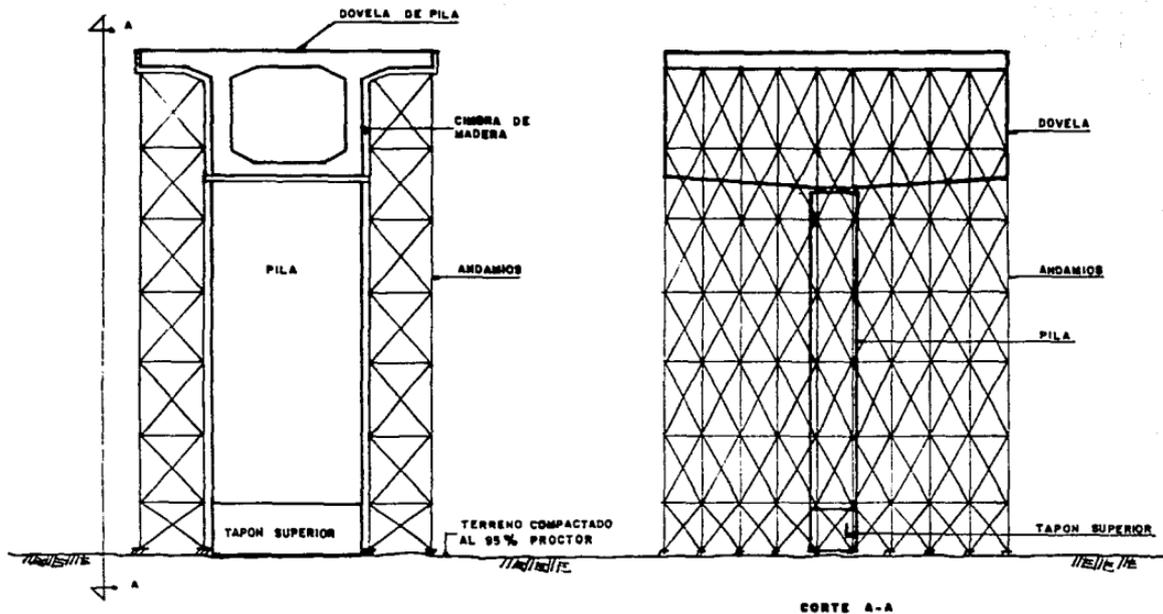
OBRA FALSA PARA DOVELA SOBRE PILA.
